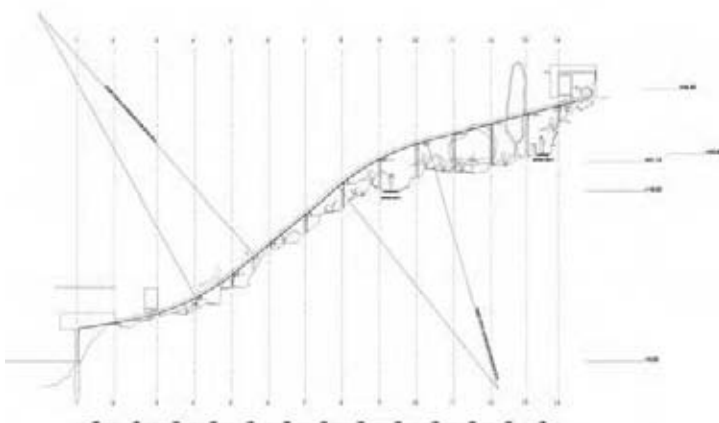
Progetto di restauro, Progetto di ascensore inclinato, inviluppo e planimetria generale.
